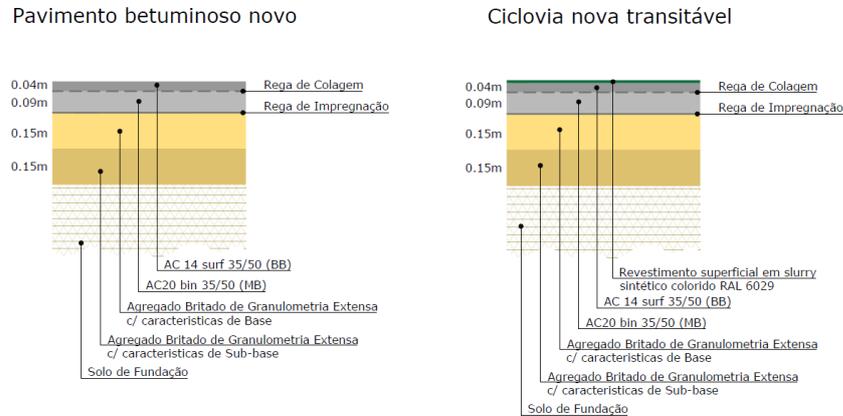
Estruturas de pavimentos betuminosos novos em zonas de alargamento ou alteração de pavimentos
